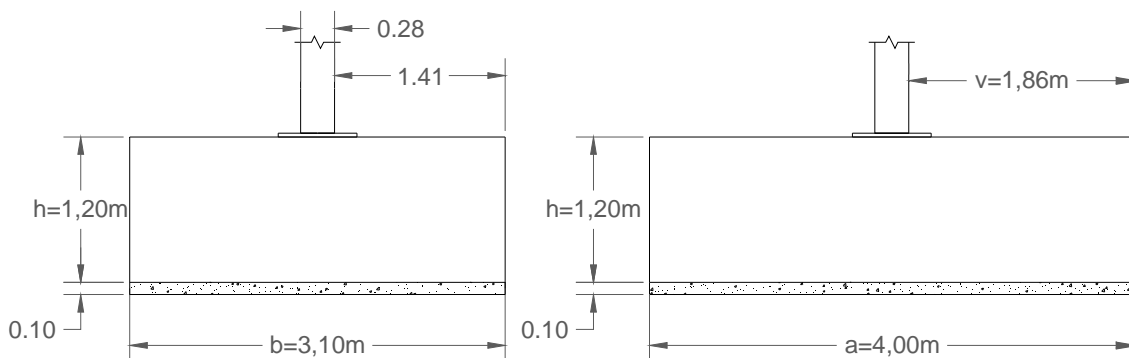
Esquema del predimensionat d'ela sabata
